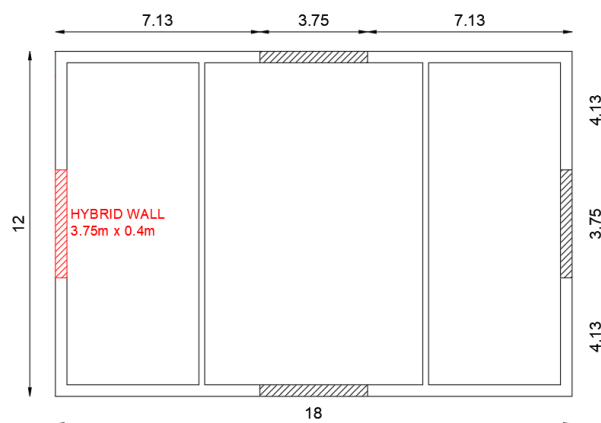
Vista schematica in pianta della struttura (dimensioni espresse in m). / Schematic plan view of the structure (dimensions in meters).
